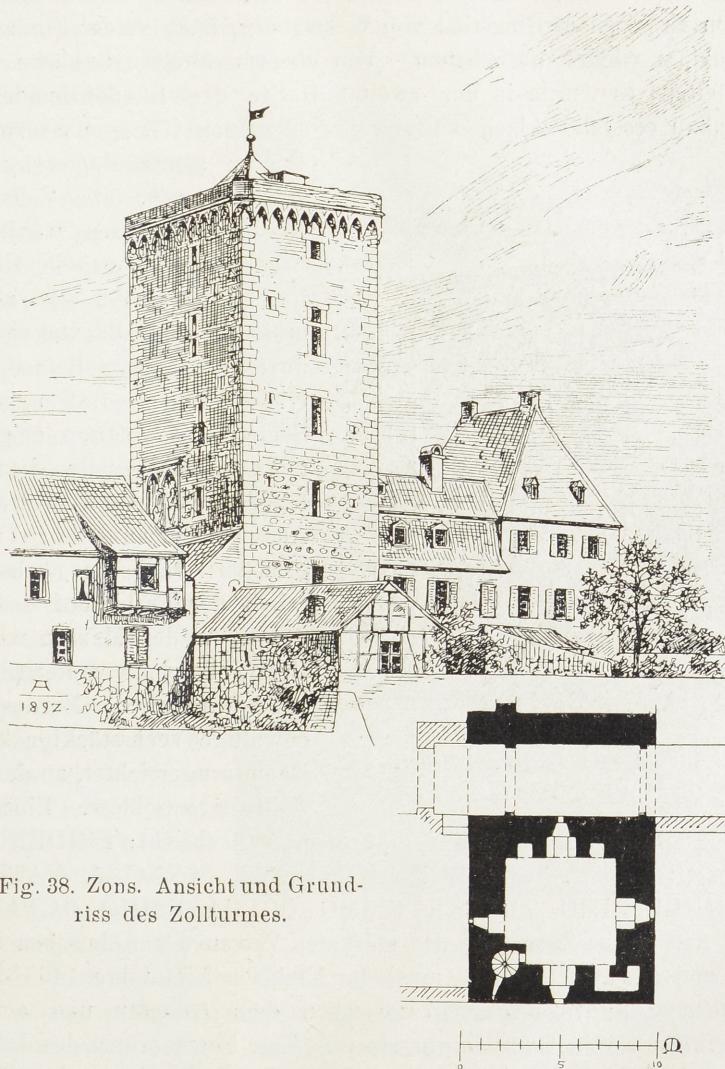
Zons. Ansicht und Grundriss des Zollturmes.
